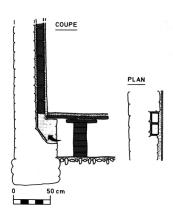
20B (état 4B): reconstitution des cheminées en coupe et en plan. Echelle 1:50.
